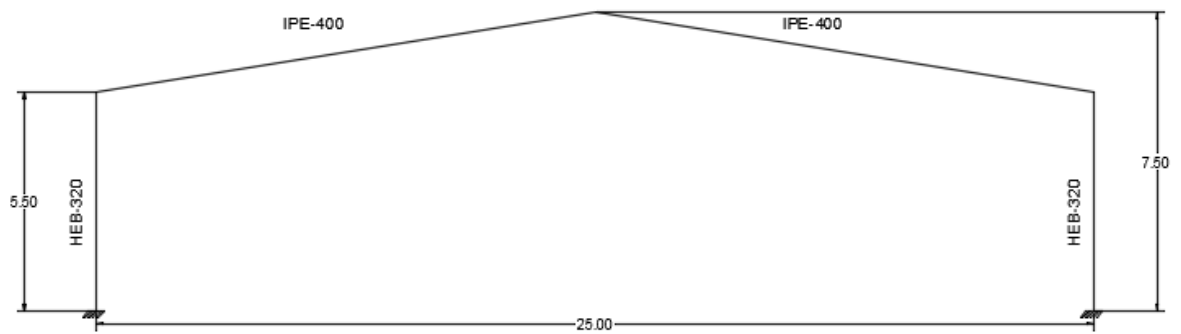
Dimensiones pórtico tipo central y perfiles de pilares y vigas
